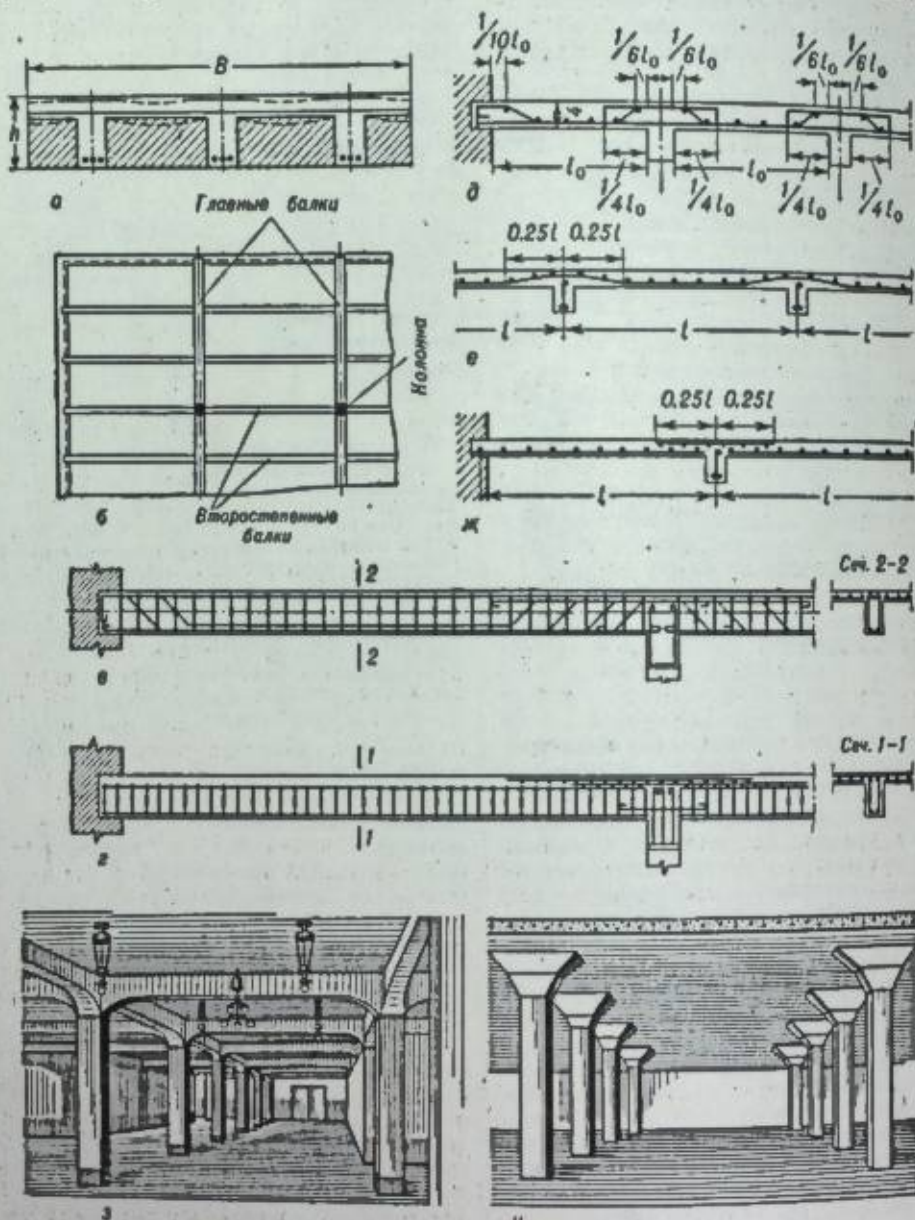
Монолитные железобетонные перекрытия: а — схема образования ребристой конструкции; б — схема ребристого перекрытия в плане; в — балка перекрытия, армированная отд. стержнями; г — то же, сварными каркасами; д — плита, армированная отд. стержнями; е — то же, сварными сетками при непрерывном армировании; ж — то же, при раздельном армировании; з — общий вид ребристого перекрытия с плитами, опирающимися по контуру; и — общий вид безбалочного перекрытия.
